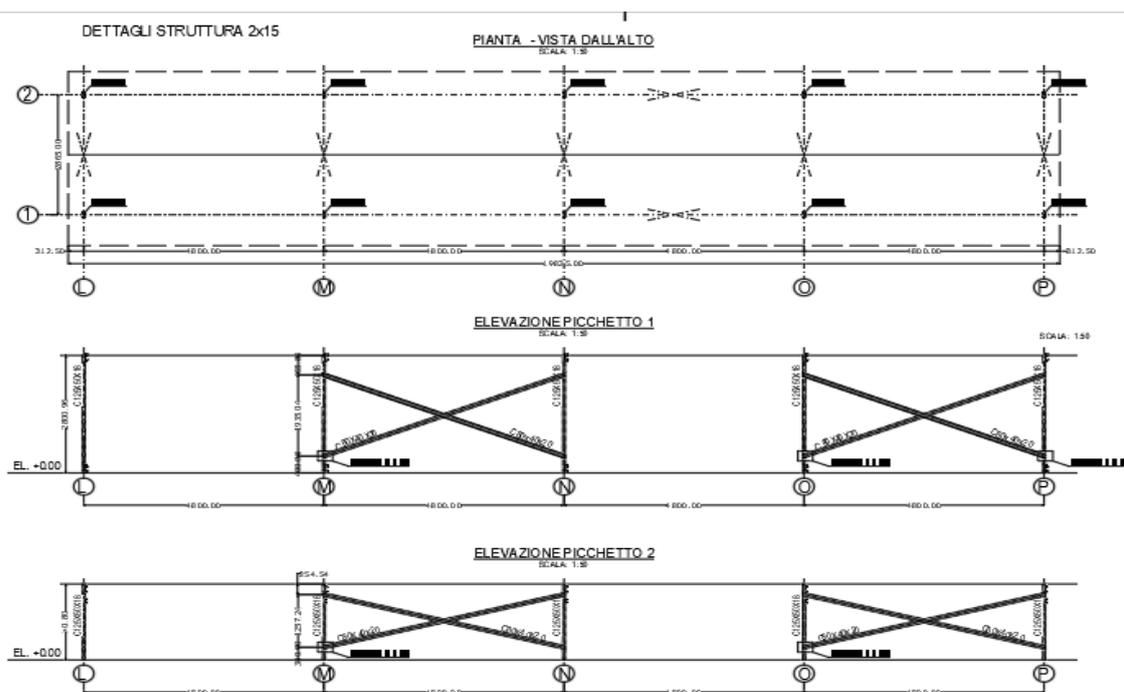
Configurazione Struttura portamoduli 2x15 (viste dall'alto e sezioni longitudinali)
